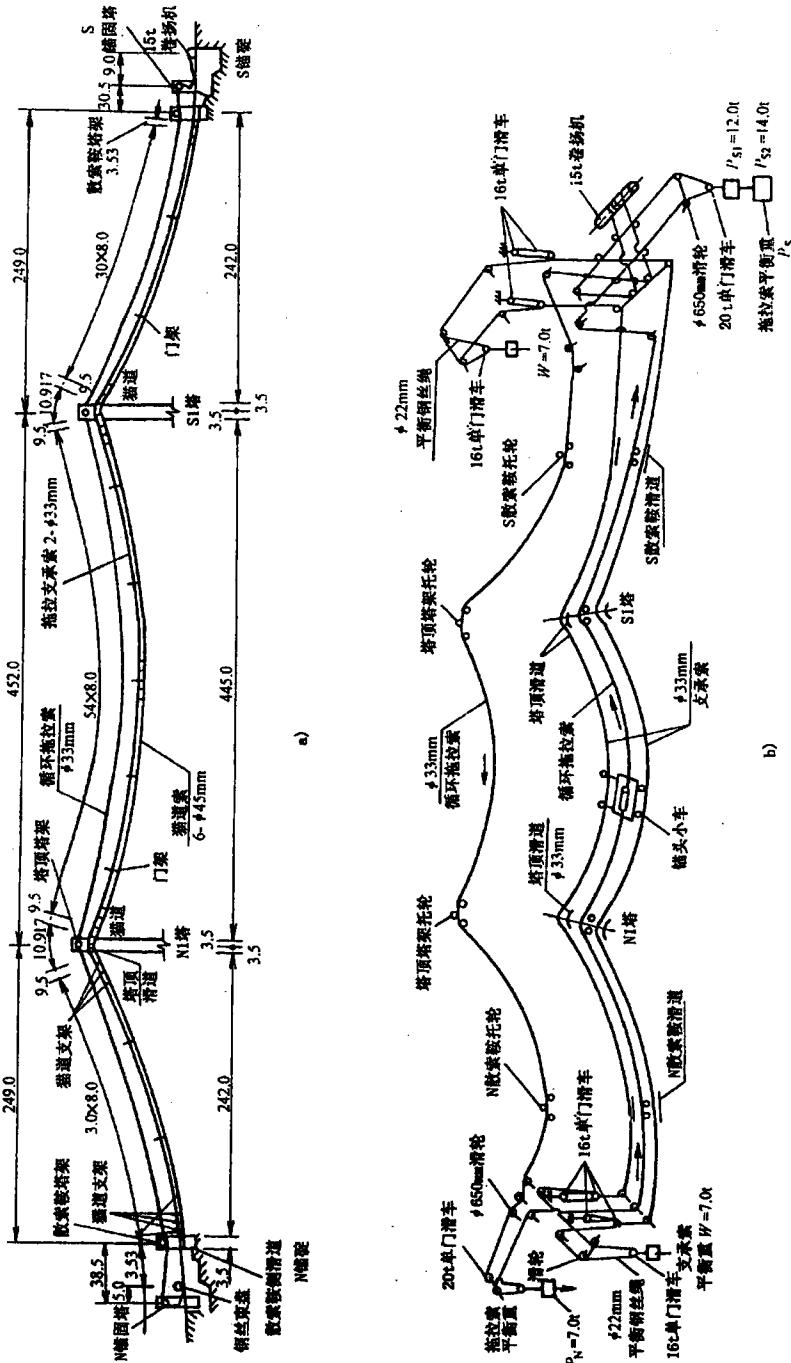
猫道及拽拉系统布置图 (尺寸单位: cm)
